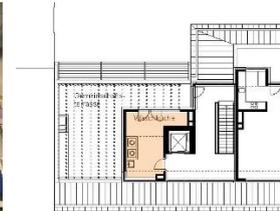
Waschküche im Dachgeschoss, Bauteil C
